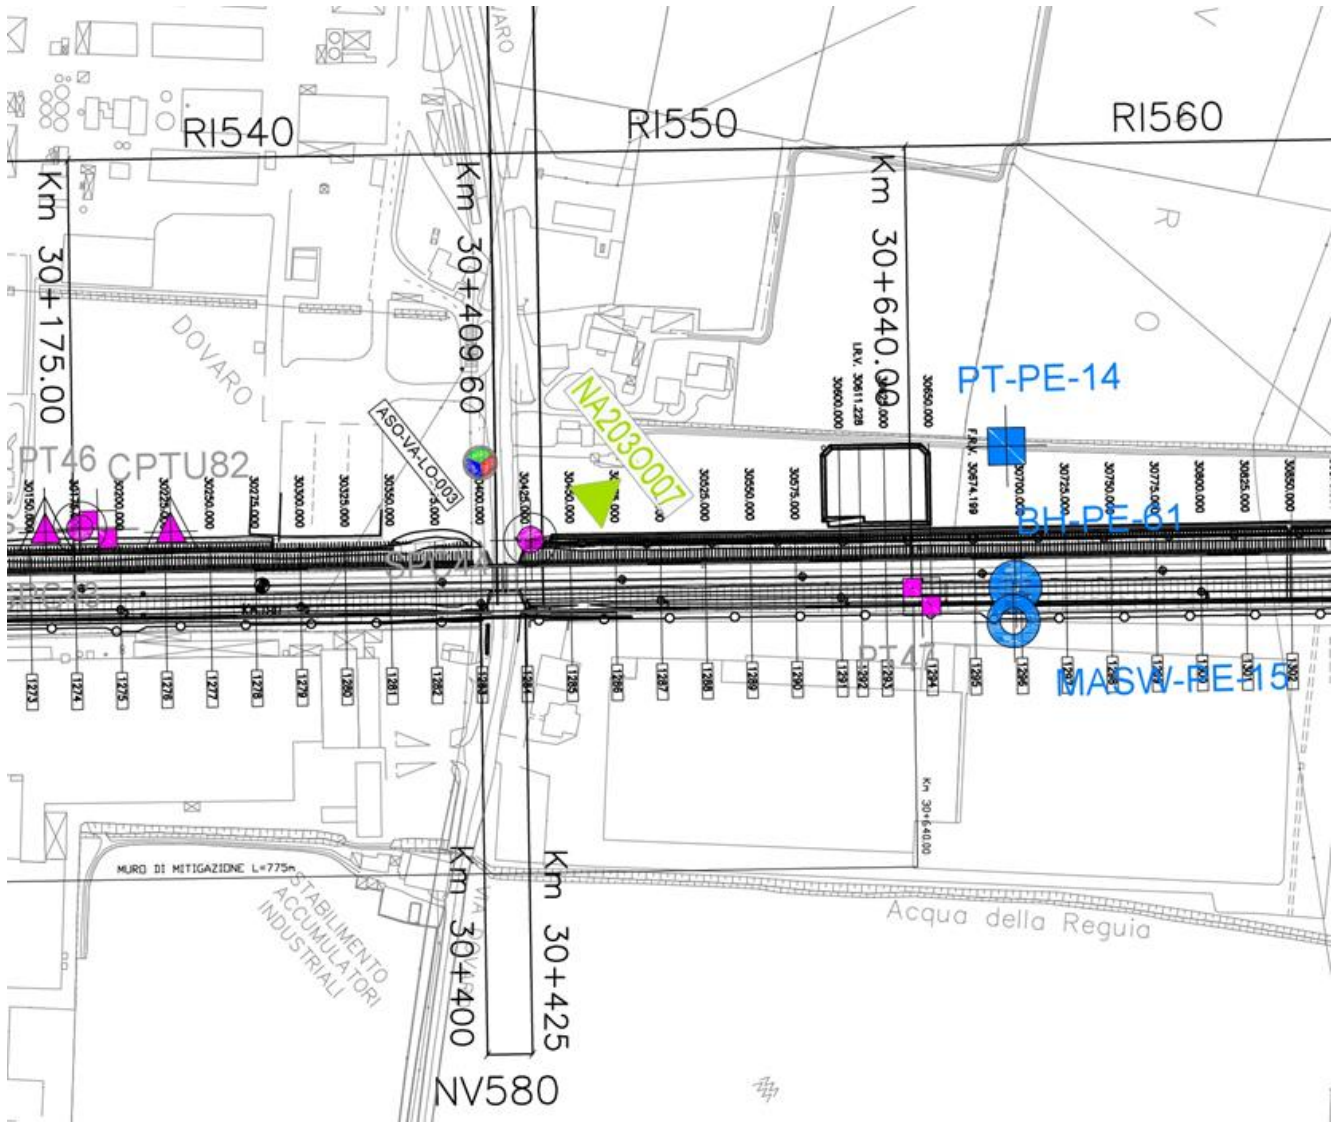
Stralcio planimetrico – Ubicazione indagini geotecniche di riferimento per l’opera in esame
